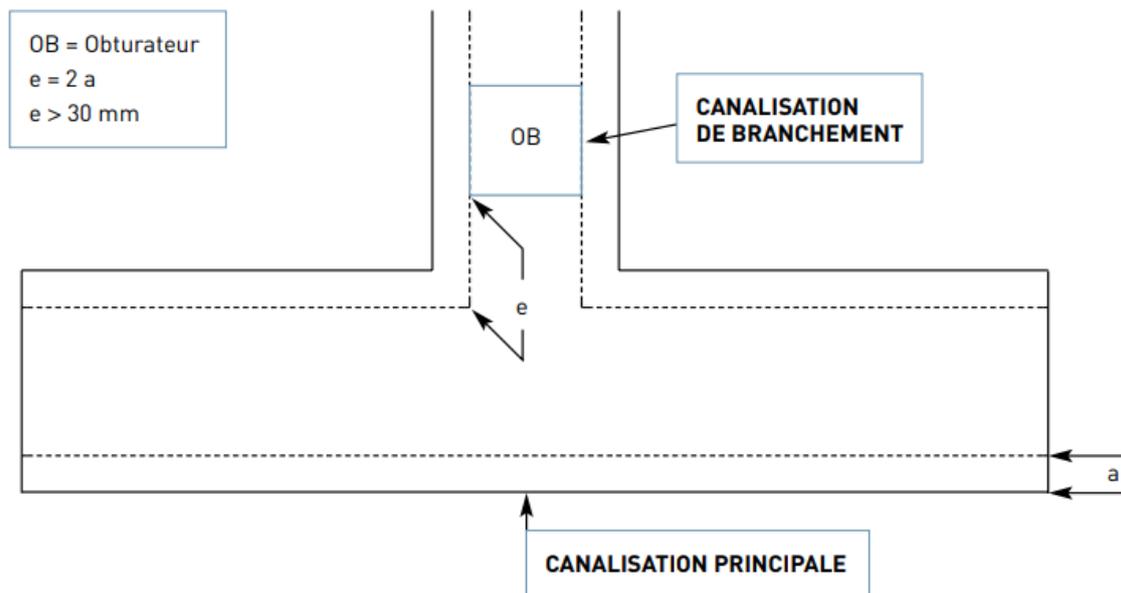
positionnement des obturateurs pour le test d'étanchéité d'un piquage de branchement
